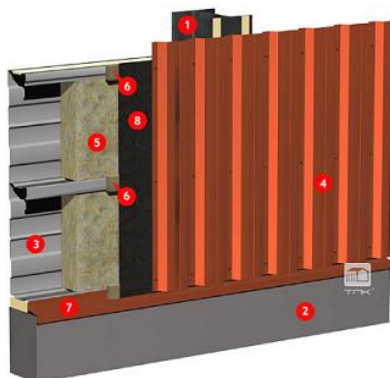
Решение наружных стен из наборных сэндвич-панелей:
